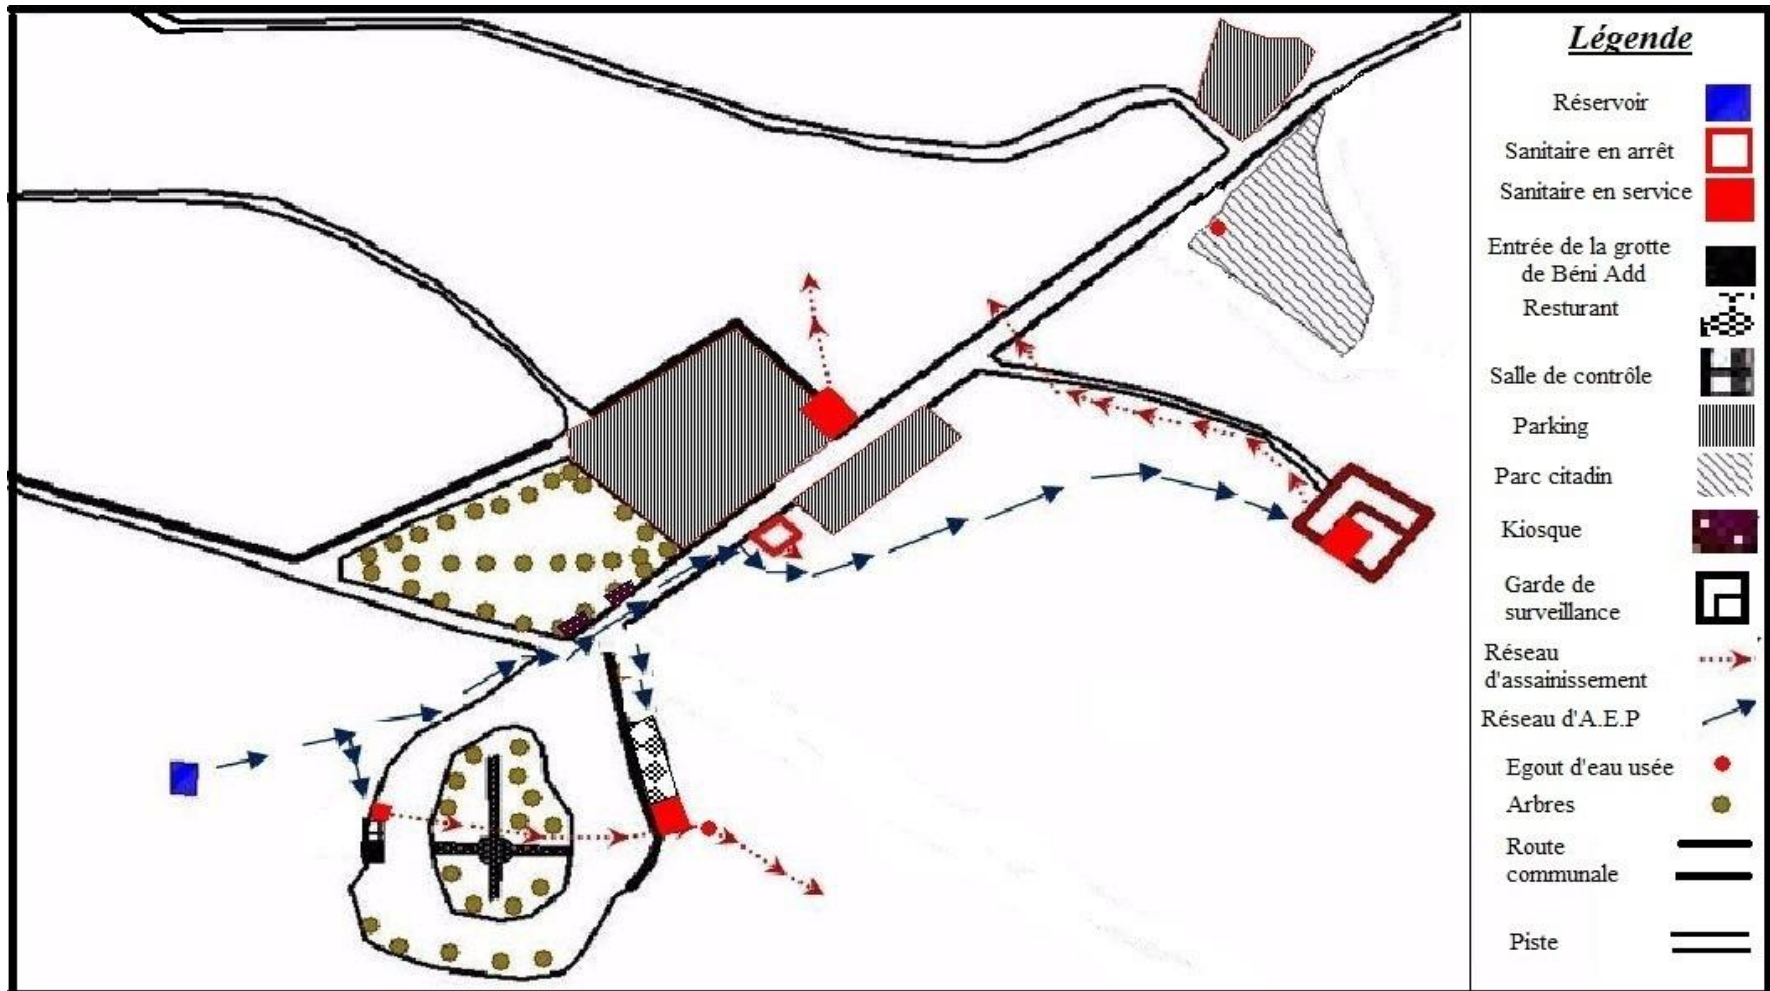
Plan d'état actuel de l'A.E.P et d'assainissement
